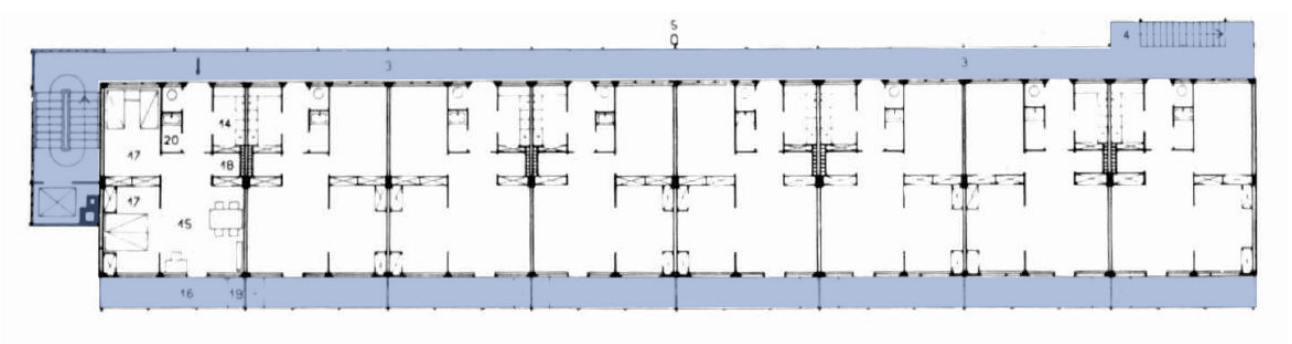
Planta tipo. Esquema señalando las terrazas y las galerías, donde se puede apreciar su proporción respecto a la anchura total del edificio.
